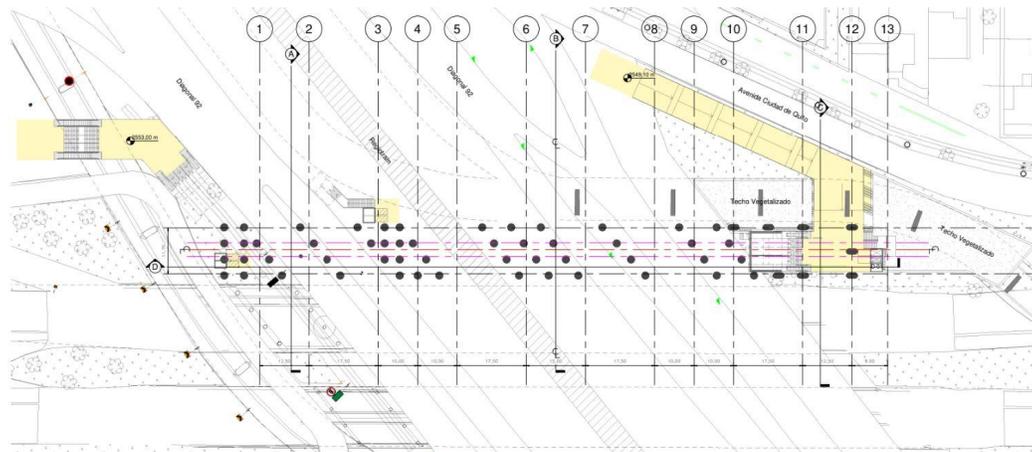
Emplazamiento Estación 18 - Calle 92 Acceso Satelital
